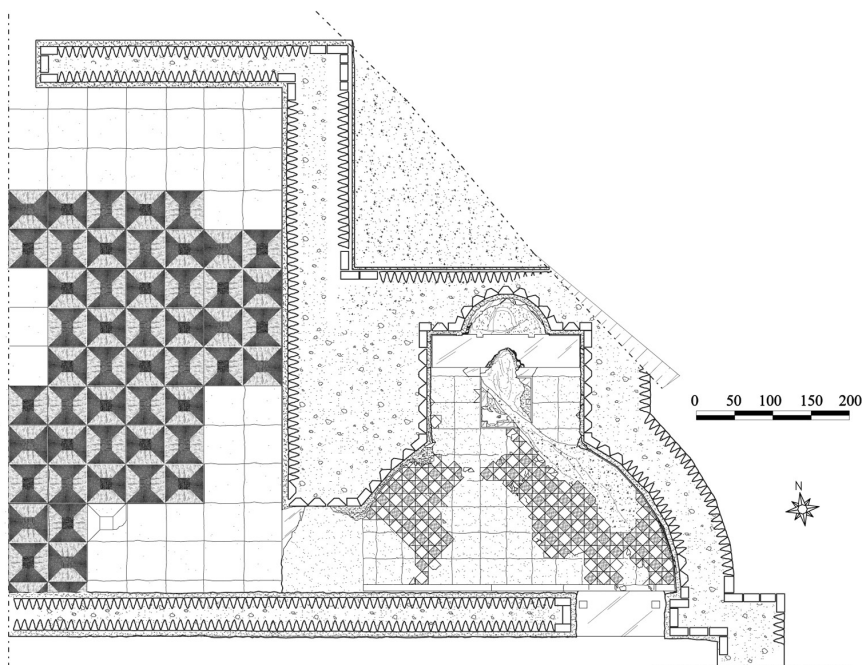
Pianta della latrina e della porzione dell'ambiente limitrofo.
